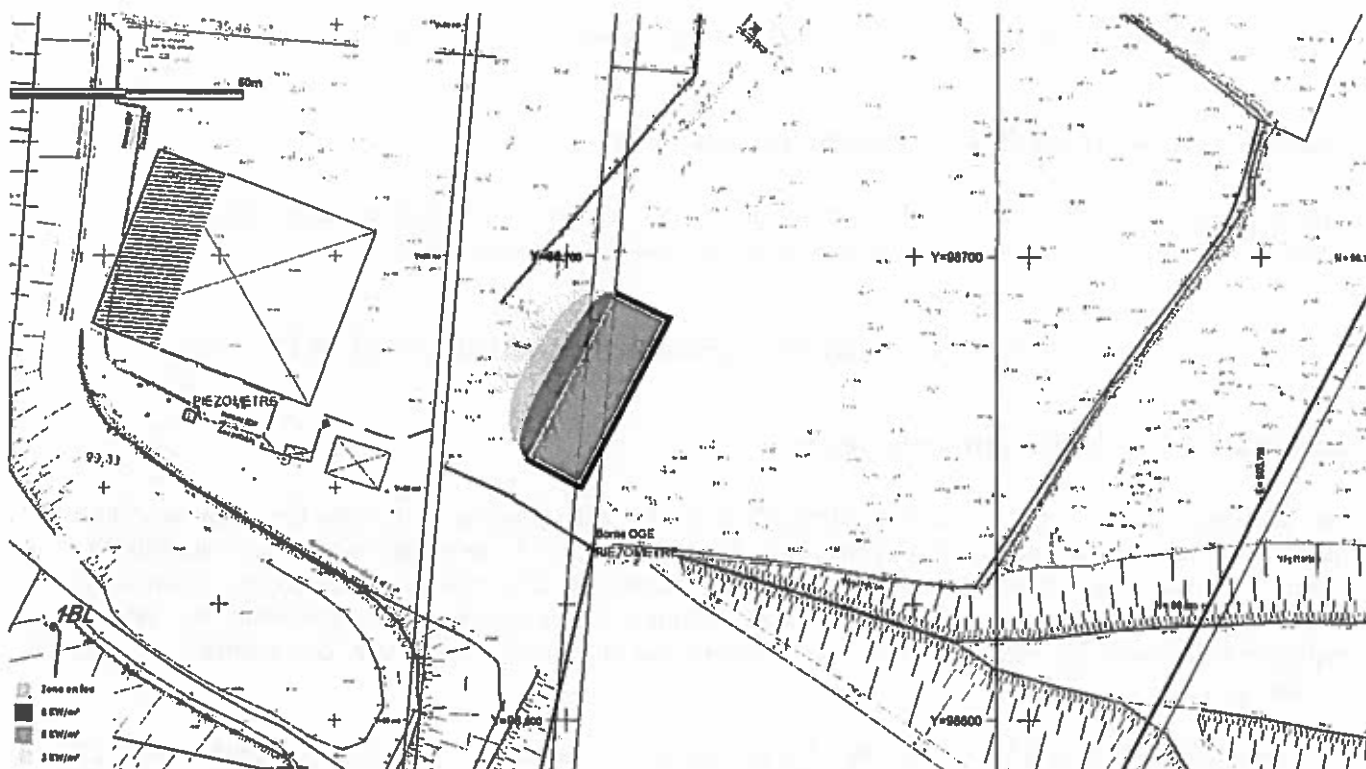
Localisation du stockage avec mur coupe feu hauteur 4m autour du stock -- CAS 1
